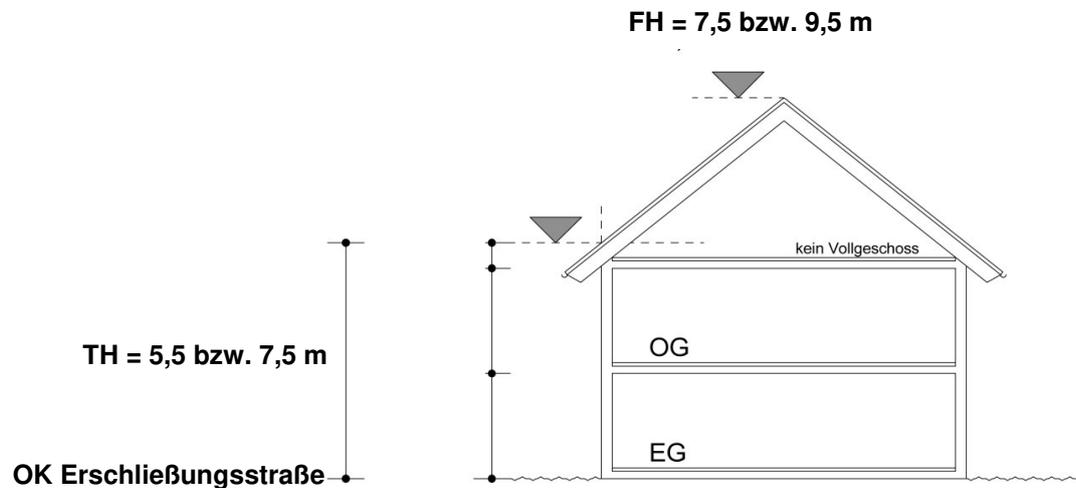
Systemschnitt zu den Höhenfestsetzungen
